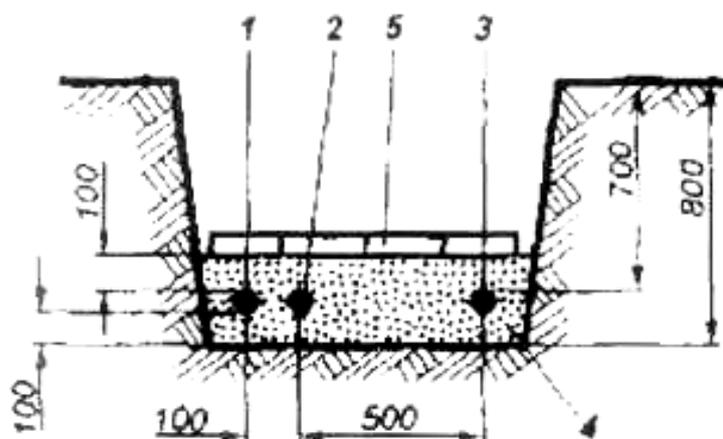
Прокладка кабелей 1...10 кВ с кабелями связи и с силовыми кабелями до 10 кВ, эксплуатируемыми другими организациями: 1 – кабель 10 кВ; 2 – кабель 1 кВ; 3 – кабель связи или силовой кабель другой организации; 4 – песок; 5 – кирпичи или плиты
